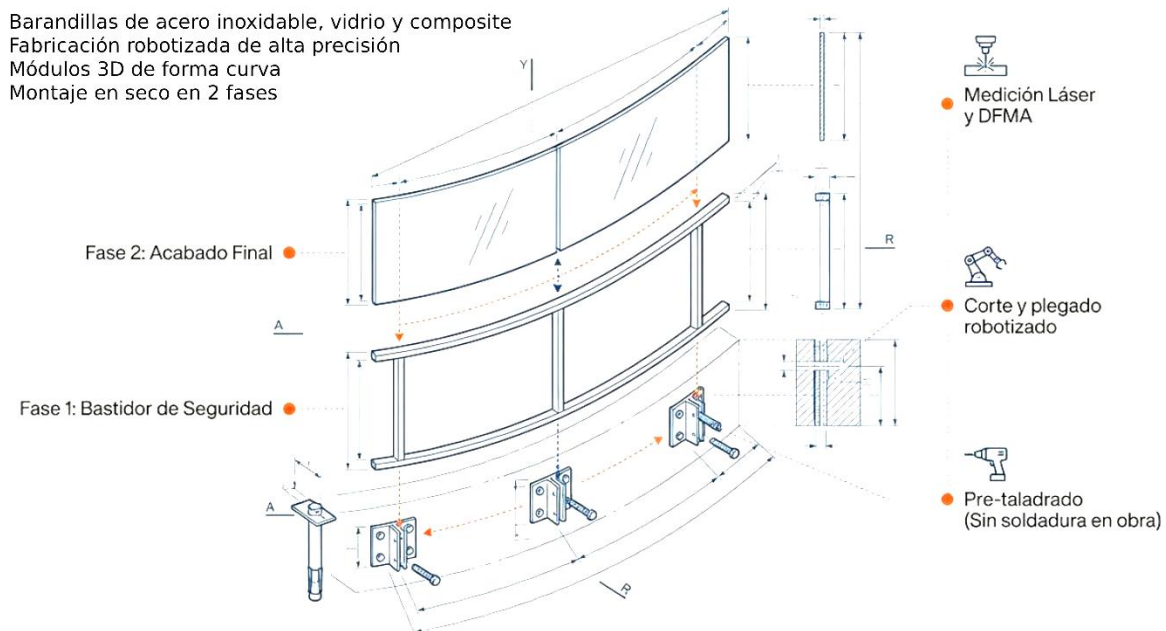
Esquema de referencia fases montaje barandillas TM Tower
